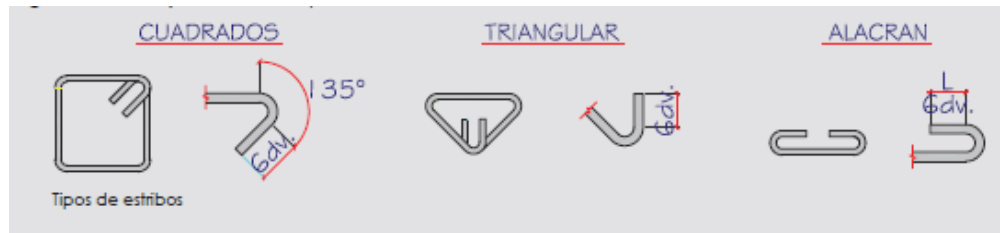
Tipos de estribos más utilizados en Nicaragua. Fuente: Nueva cartilla de la construcción. 2011. MTI
